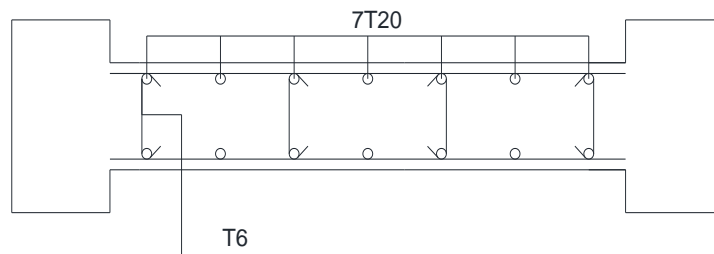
Schéma de ferrailage du voile (poutres noyées – bâtiment R+7)
